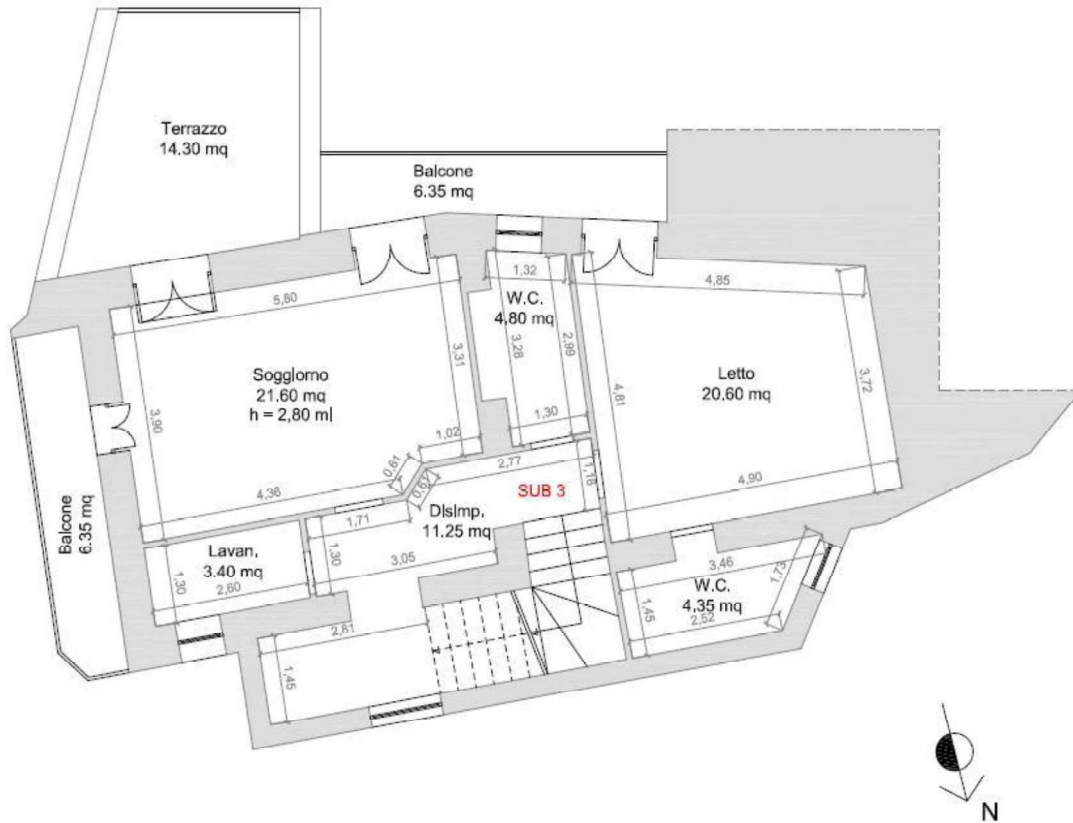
Planimetria Stato di Fatto Immobile, Piano 2, Foglio 35, p.lla 817, Sub 3.
